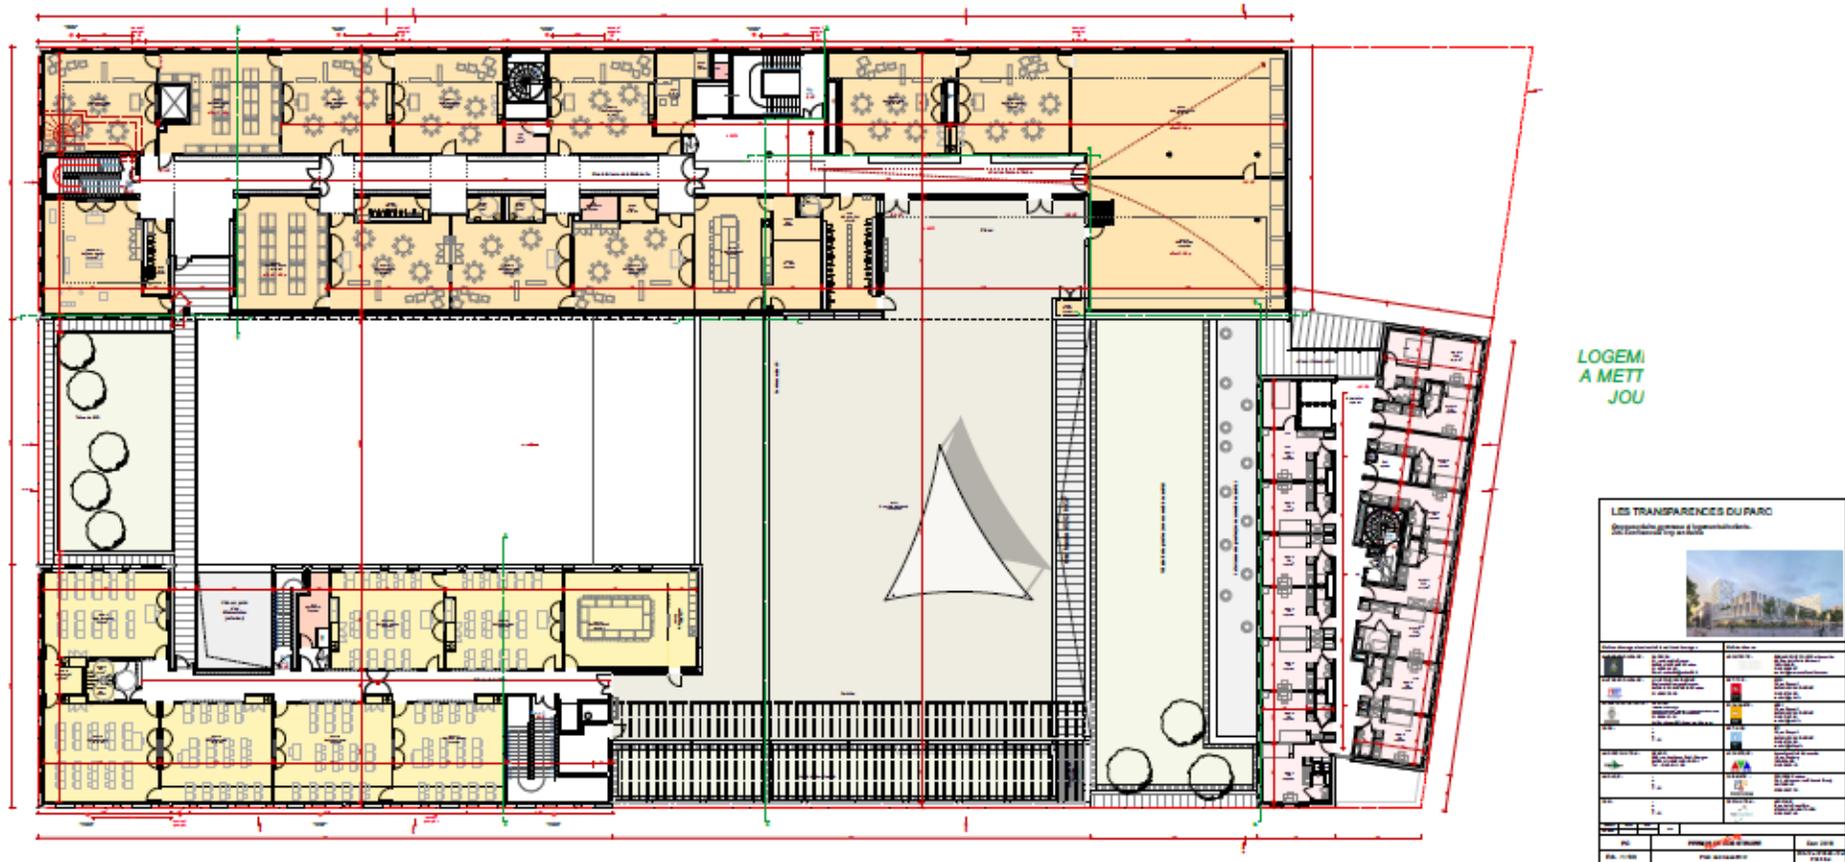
Plan de masse : Niveau 2<sup>ème</sup> étage
